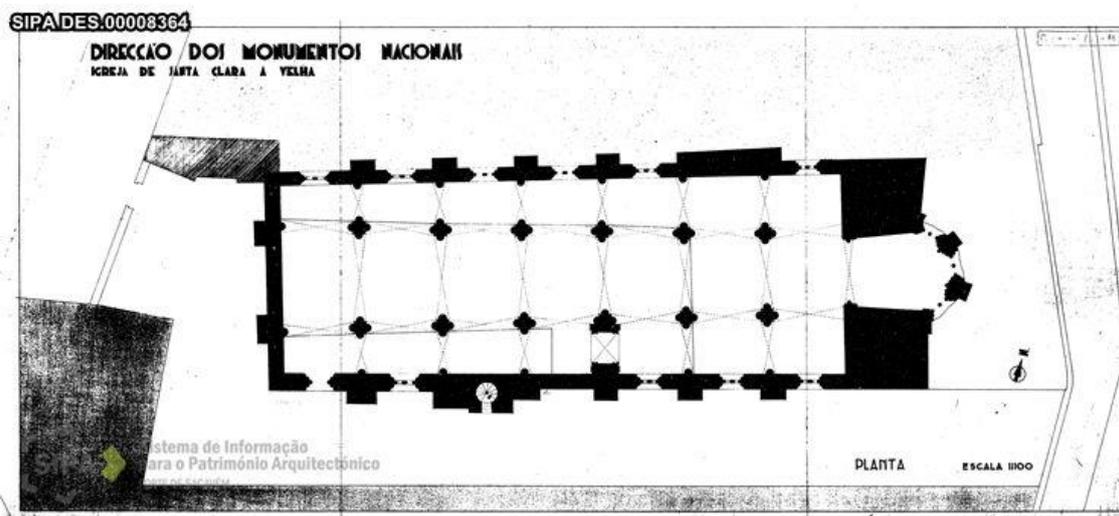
Planta da Igreja do Convento de Santa Clara-A-Velha de Coimbra
